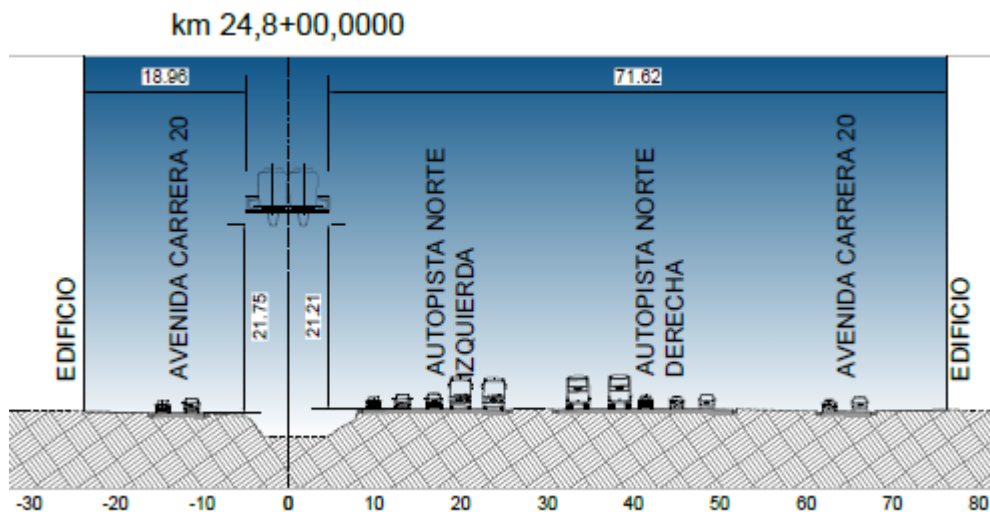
Sección transversal en vía elevada en PK 24+800
